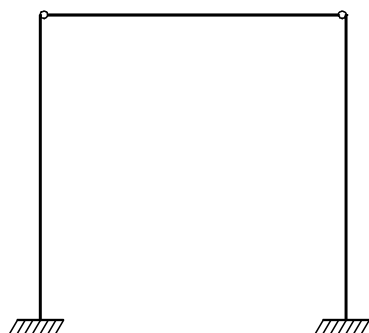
Pilar engastado na fundação e viga articulada nos pilares (apud EL DEBS, 1996).
